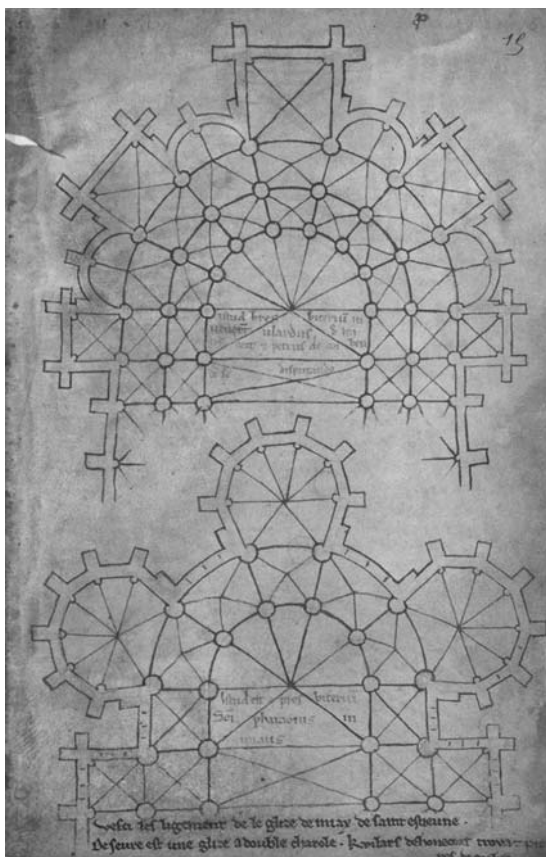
Villard de Honnecourt, Grundriss der Kathedrale von Meaux (unten); erfundener Grundriss (oben), um 1230
